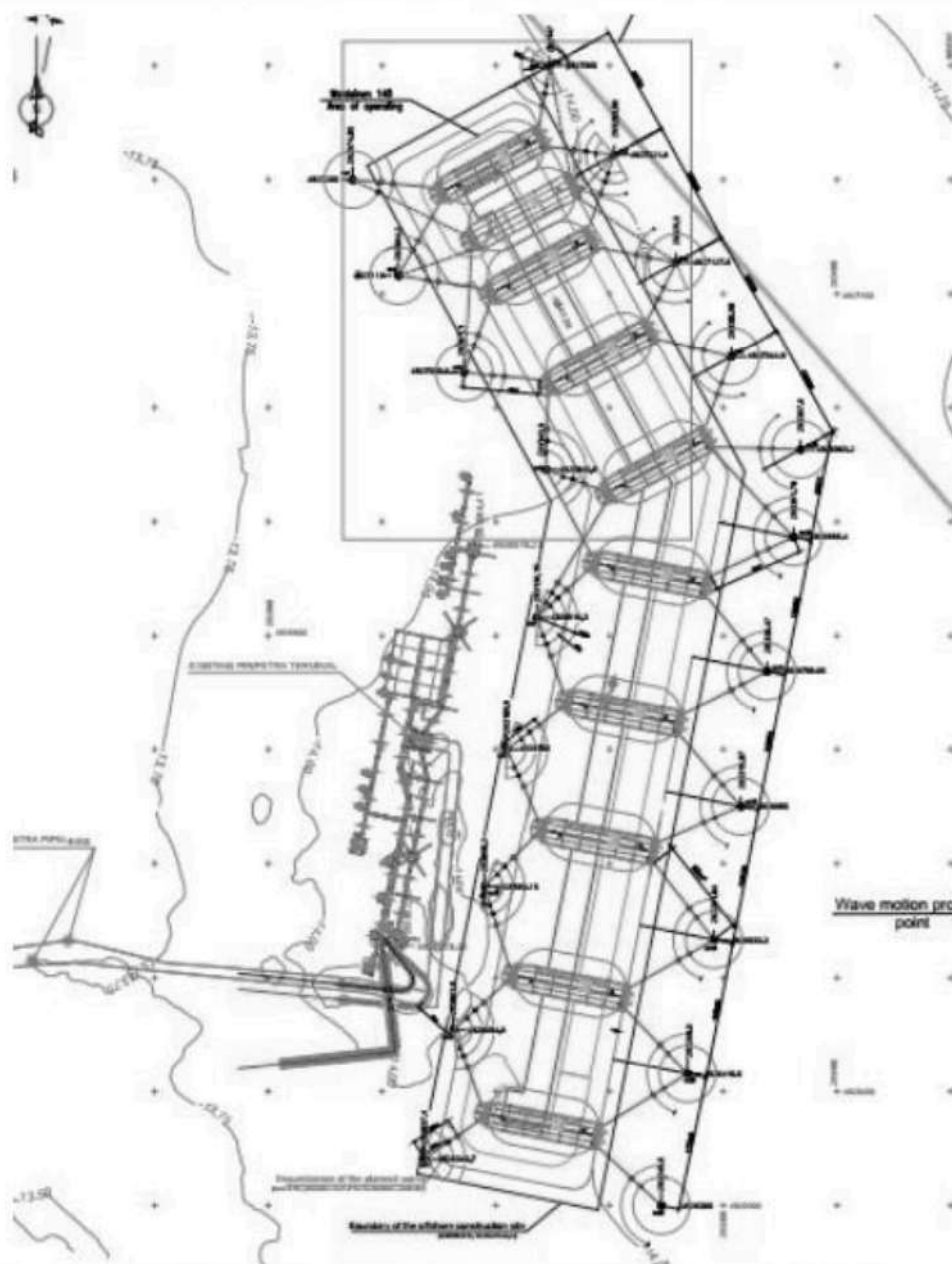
Planimetria con ubicazione dei n. 22 punti di installazione, elaborato RAV-KM-911-010-01 D Barge VISTA Operating in area por RAVENNA
